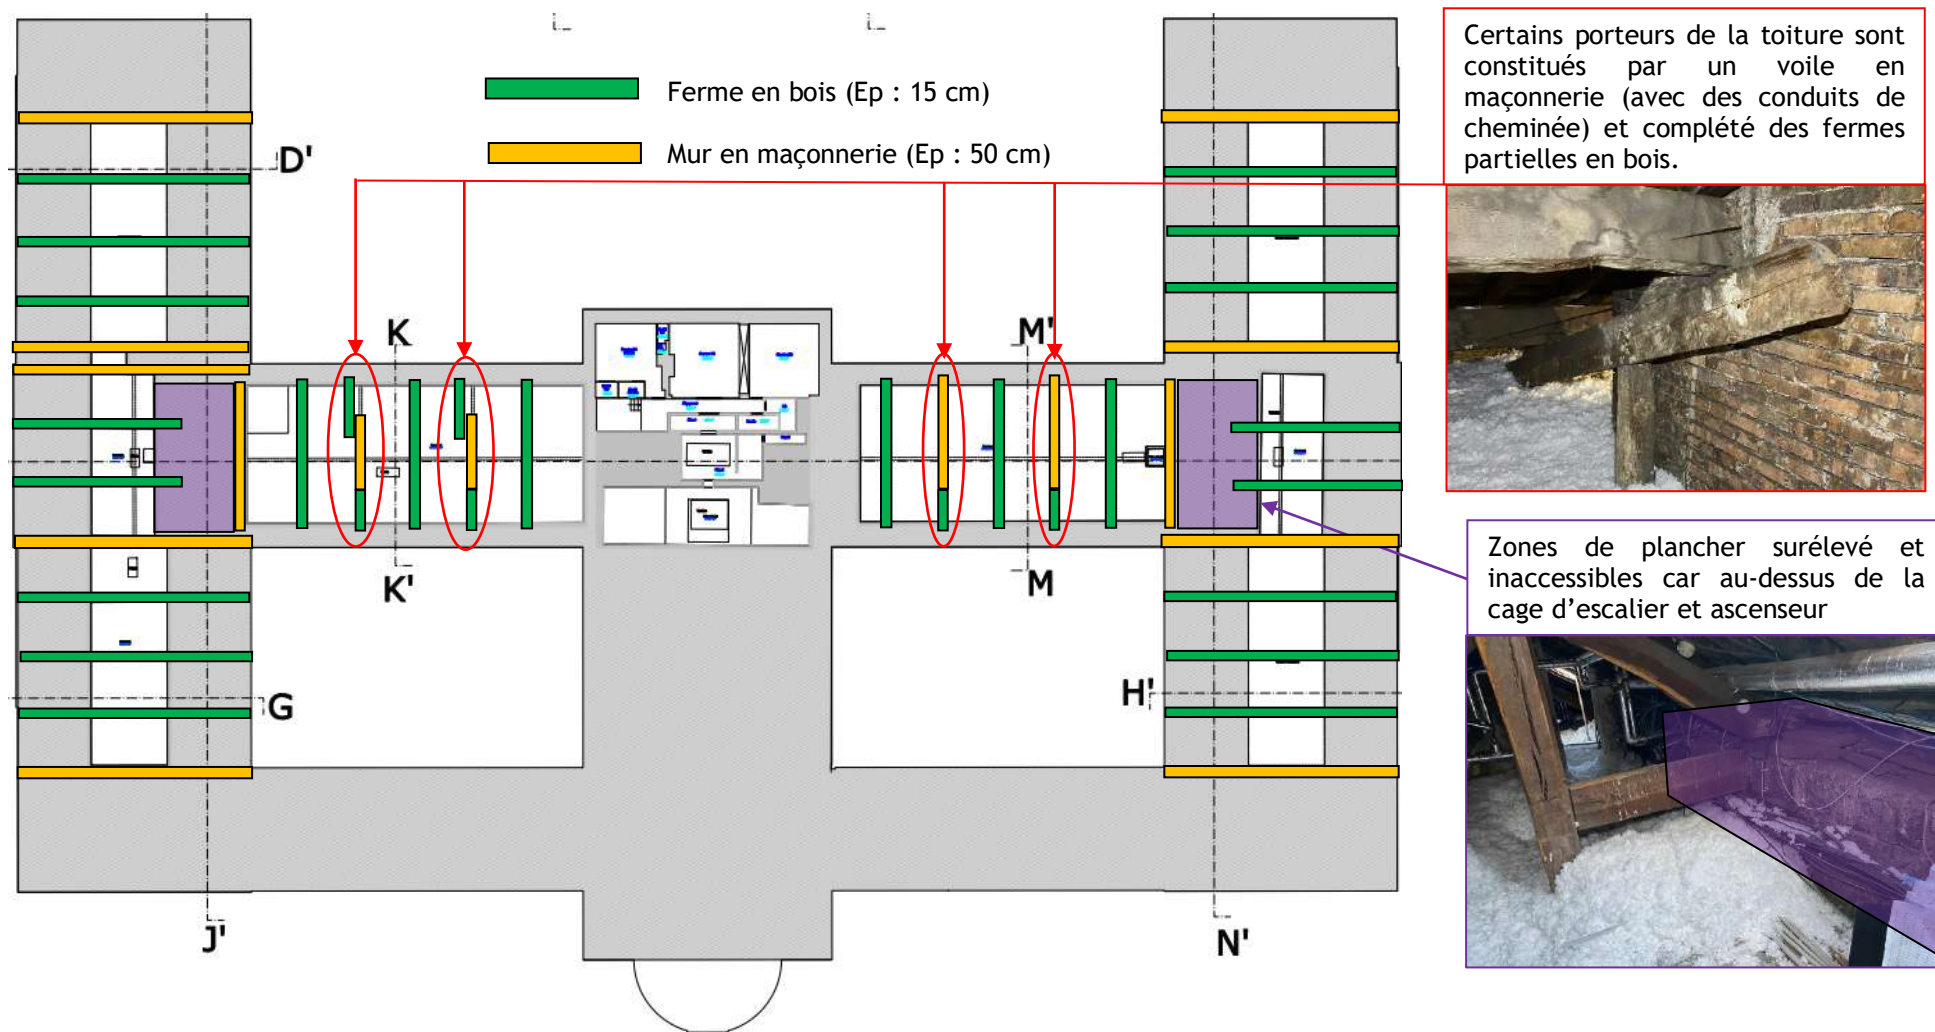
Principe structurel sur fond de plan des combles géomètre - Vue de dessus
